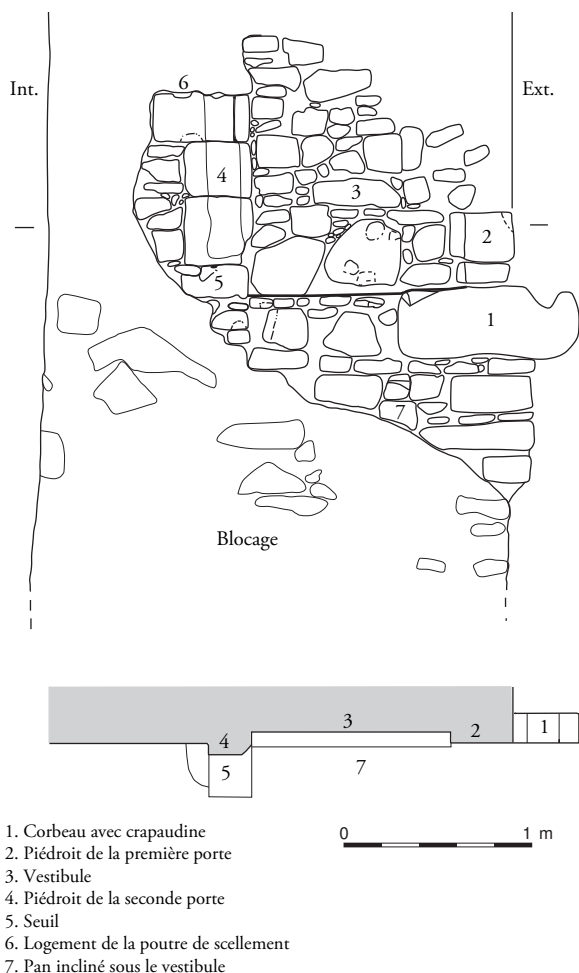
Porte du donjon. Élévation et plan des vestiges (relevé Laurent Marciniak ; DAO Claudia Flaus, Cédric Moulis).
